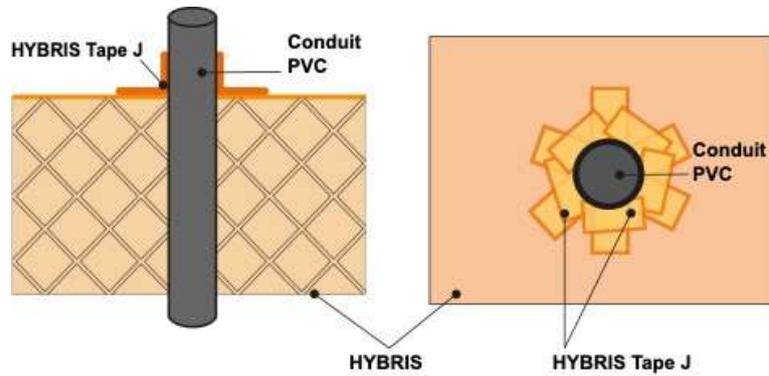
Passage conduit PVC étanché avec l'adhésif TAPE-J (100 mm)
